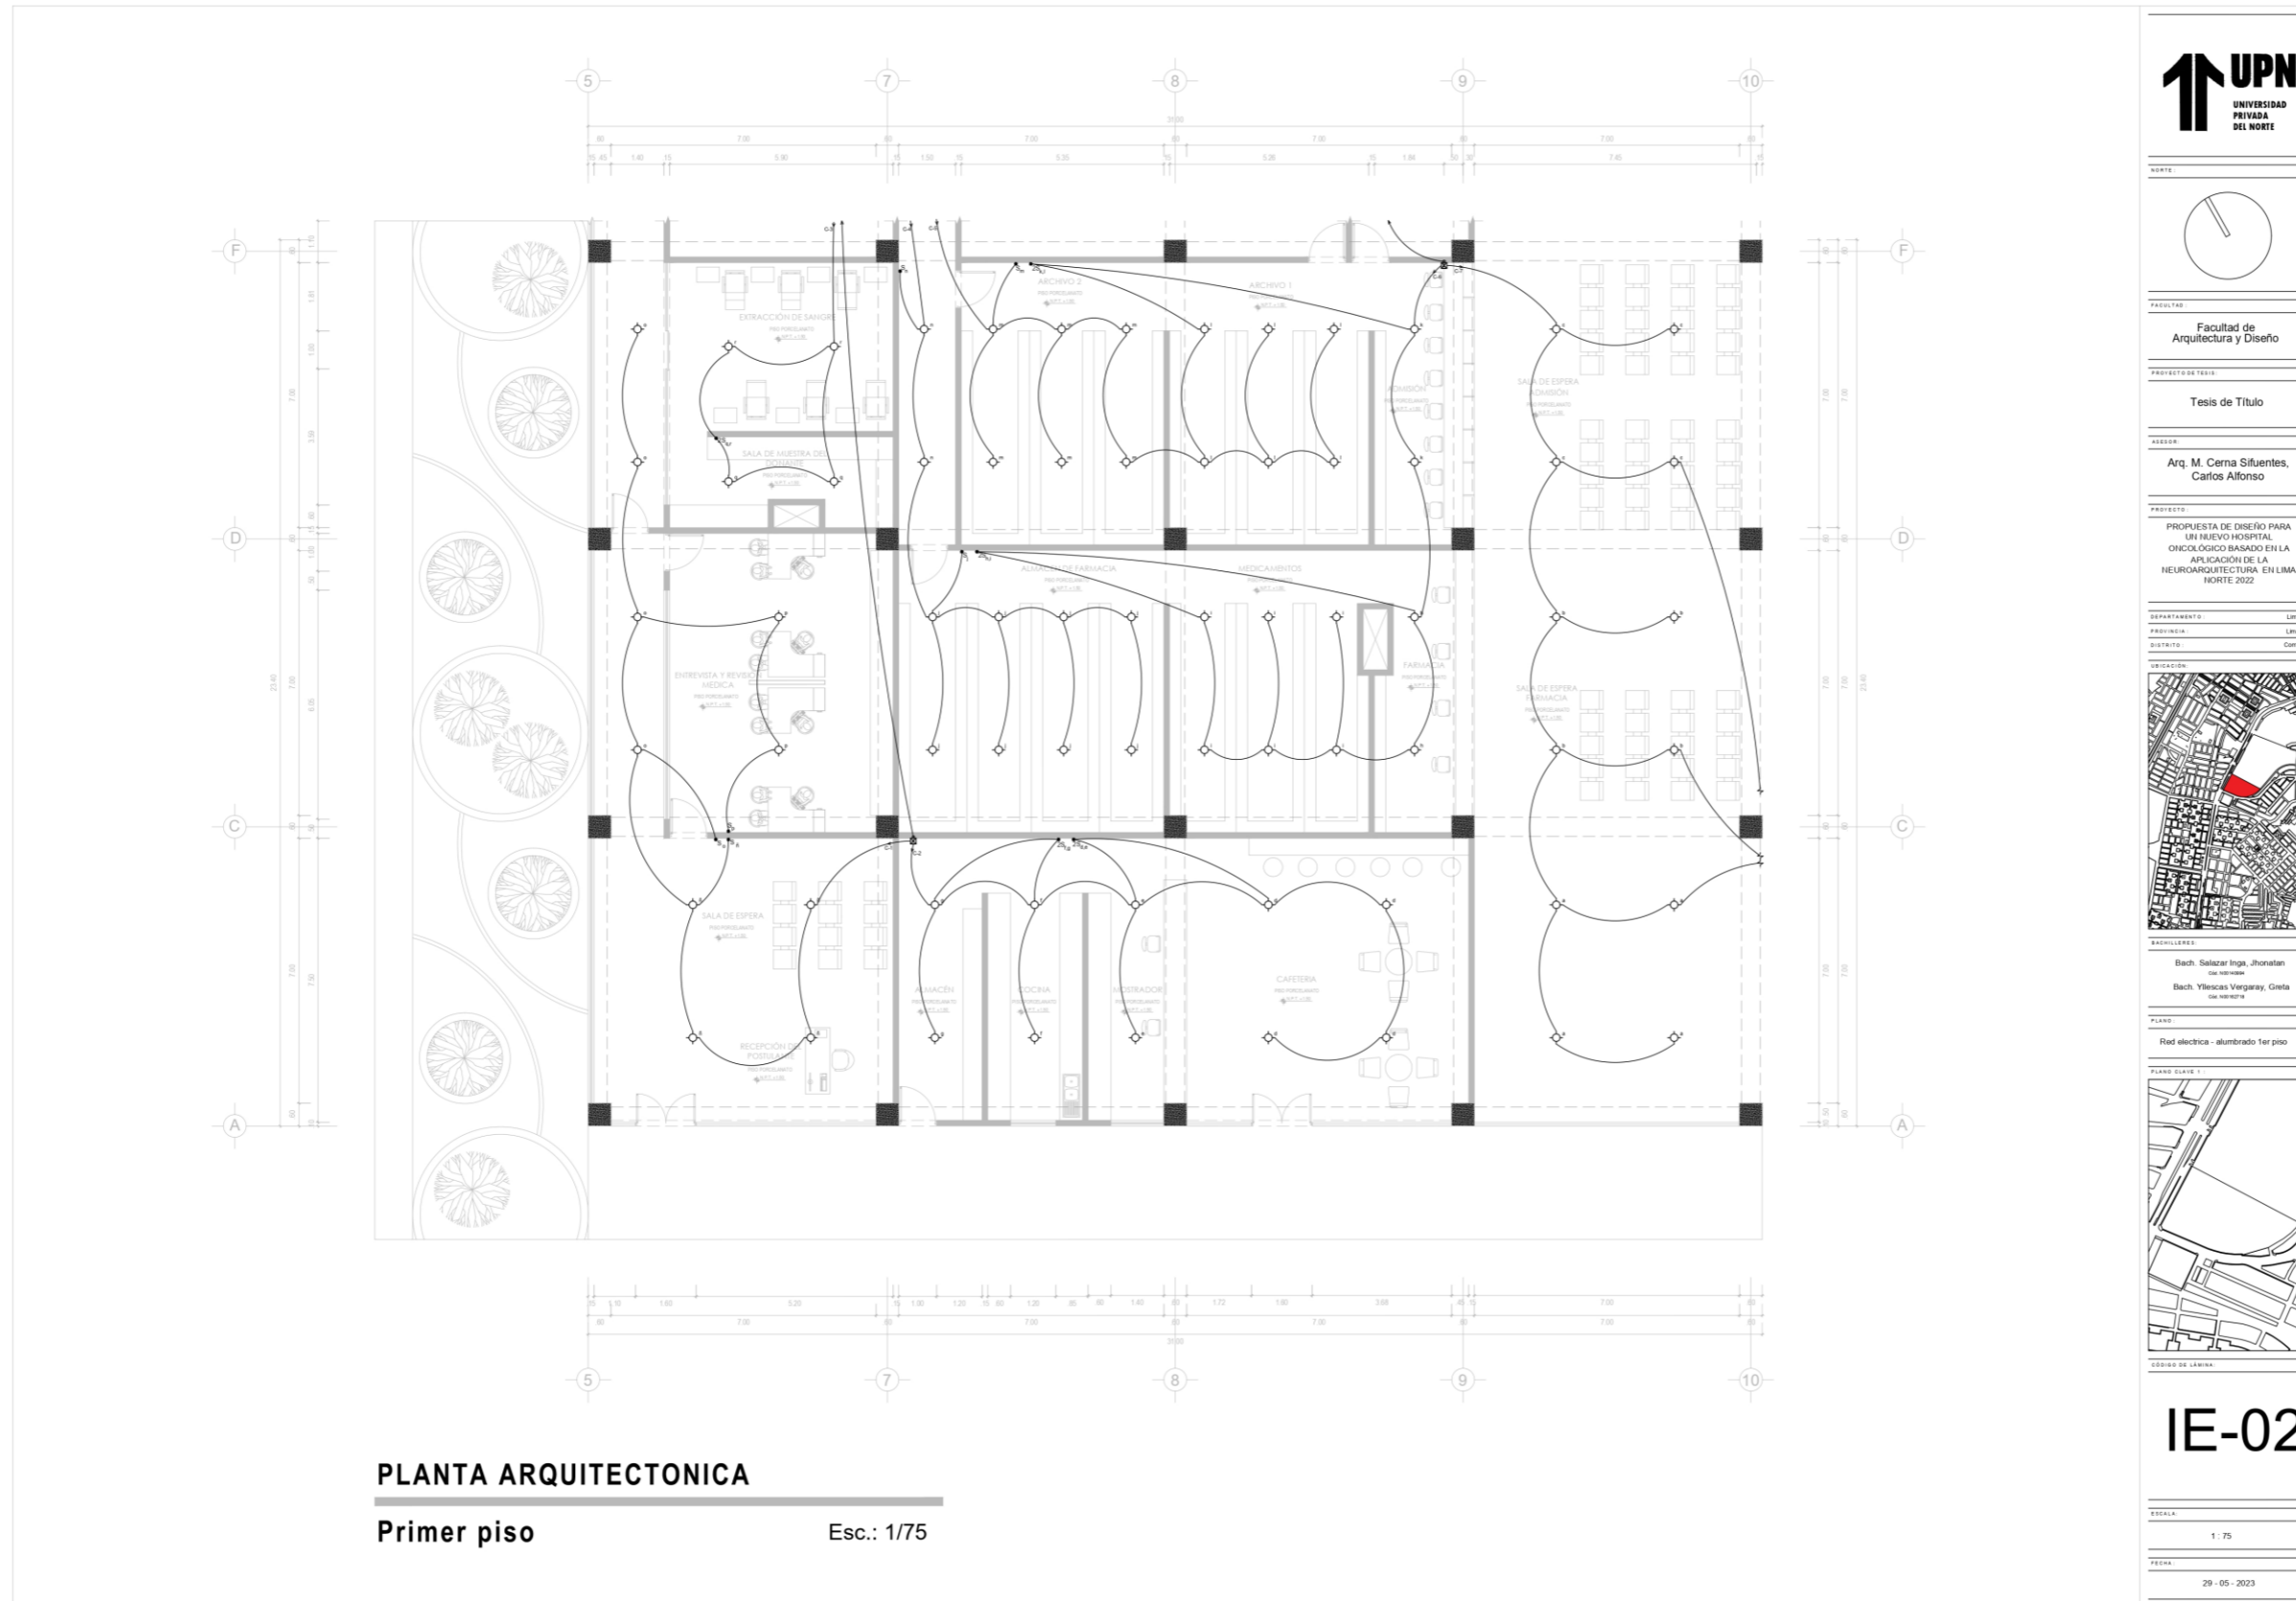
Instalaciones Eléctricas – Alumbrado nivel N°1 del sector cuadrante Esc: 1/75 (Fuente: Elaboración propia de los coautores)
